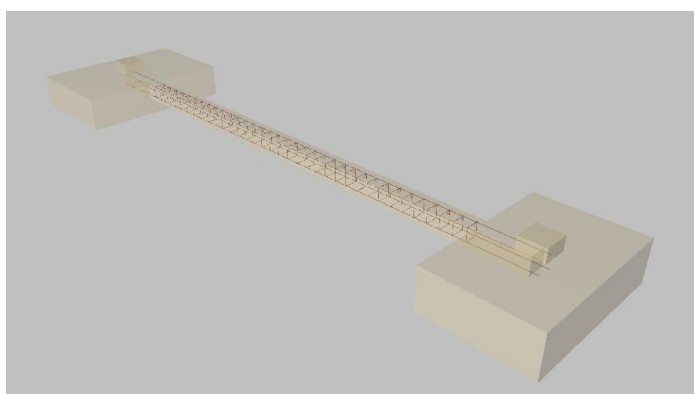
Vistas 3D de una zapata ampliada y de las vigas de atado
